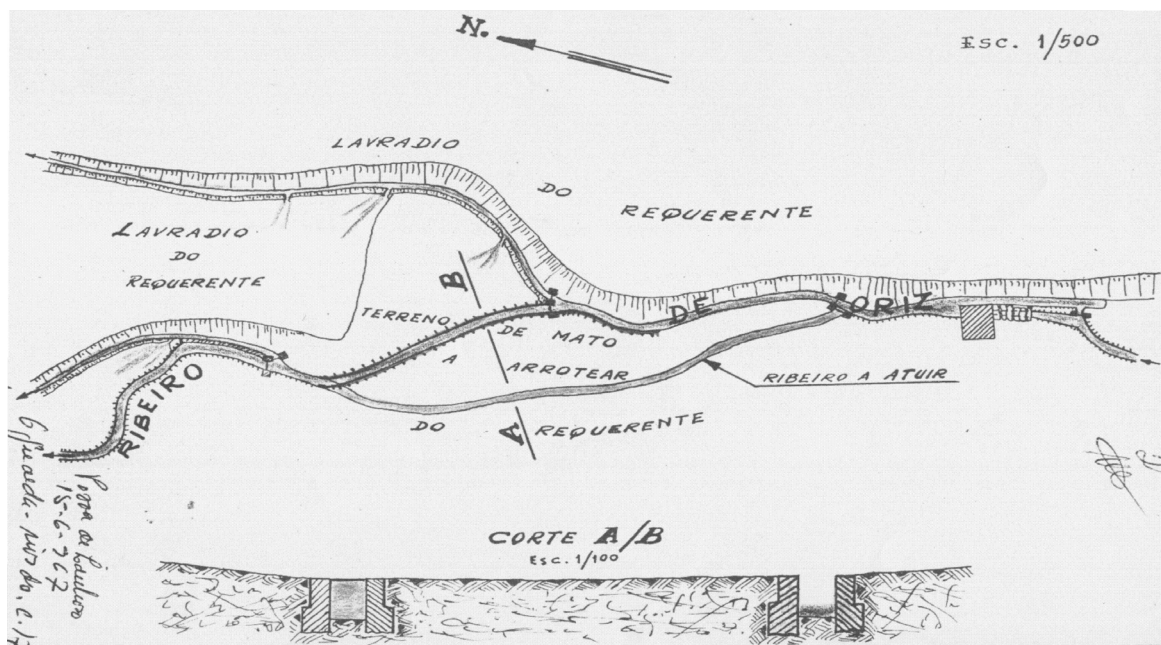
Planta e cortes relativos ao processo para construir um novo alinhamento do leito do ribeiro de Oriz (Ribeira, Gonça, Guimarães, 1967). (Fonte: APA)
